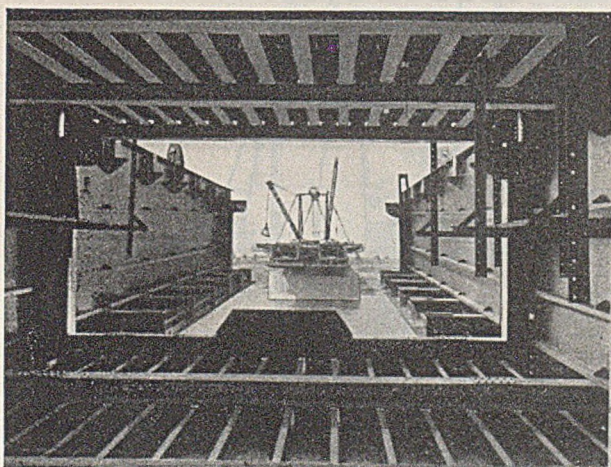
Innenaufnahme aus dem Hohlkasten heraus.
